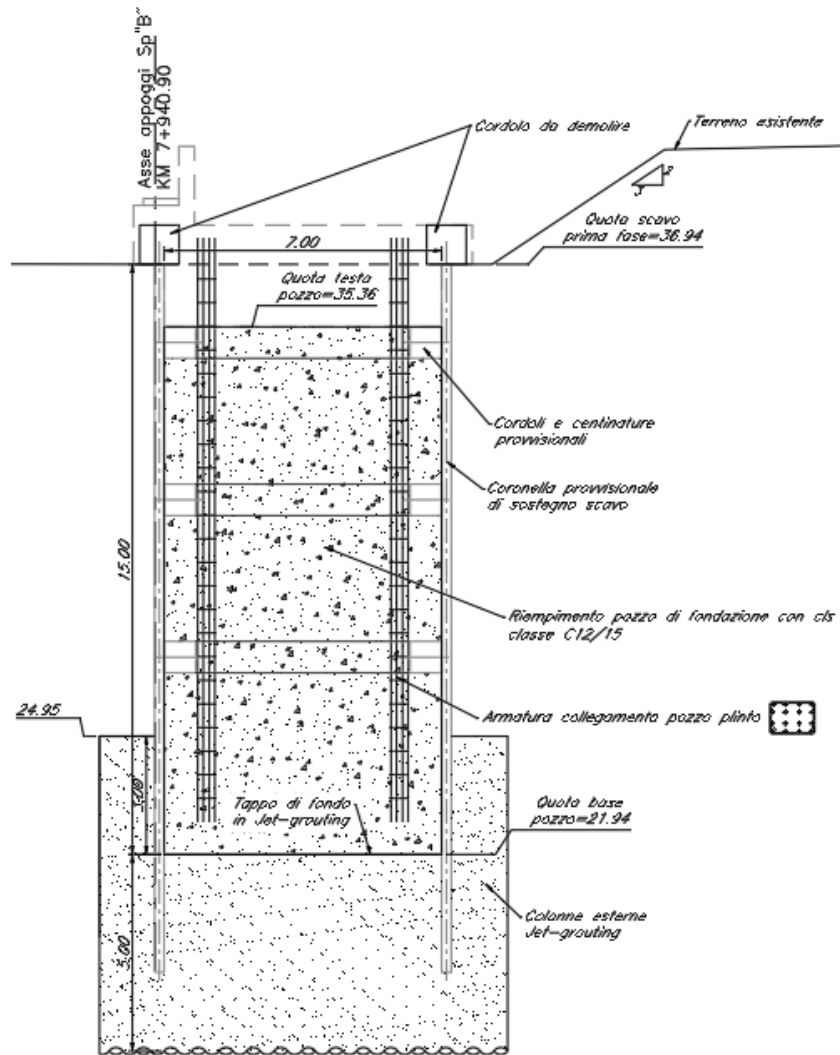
Sezione longitudinale trattamento con jetgrouting
